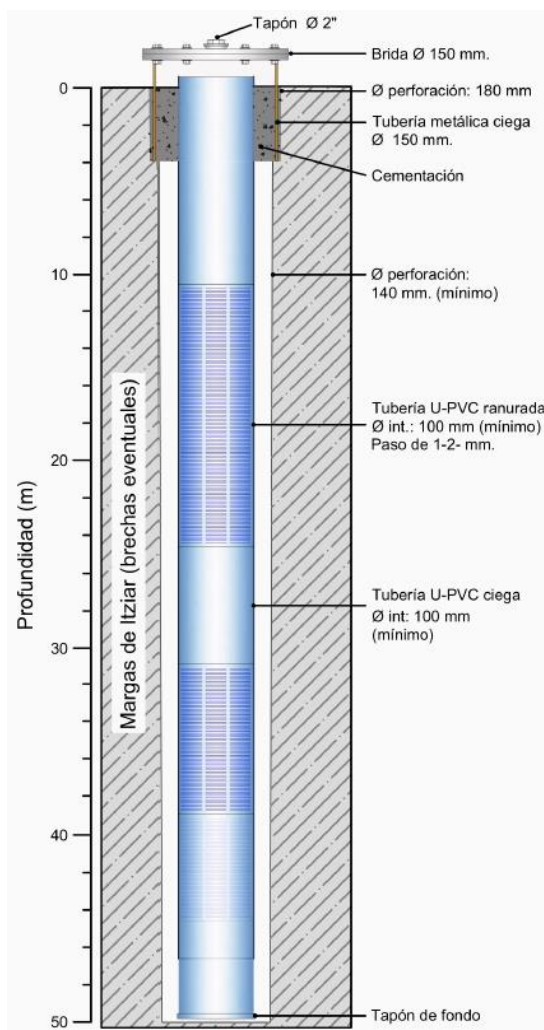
Esquema constructivo de los piezómetros Urberuaga-1 y 2.
